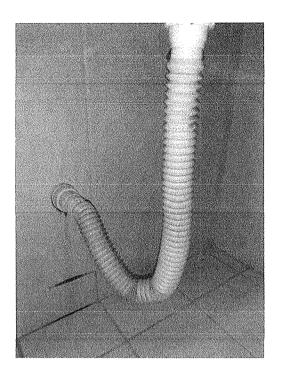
Sifão com vazamento (apresenta em outros pontos da cozinha)
